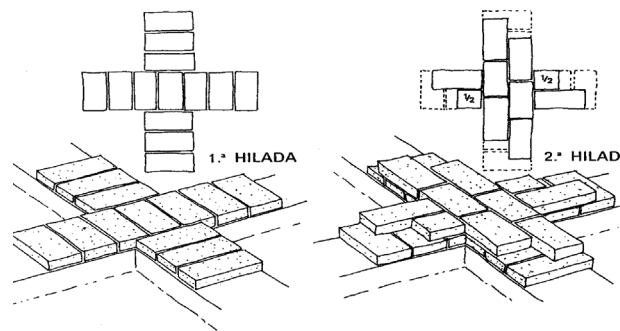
Encuentro de muro en "I" con ladrillos opuestos.
